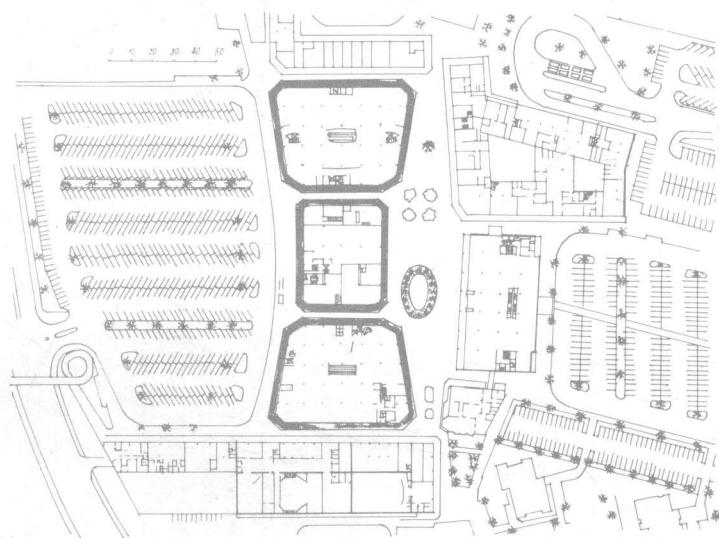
9. 瑞典斯德哥尔摩市法斯塔(Fasta)中心商业区平面图
